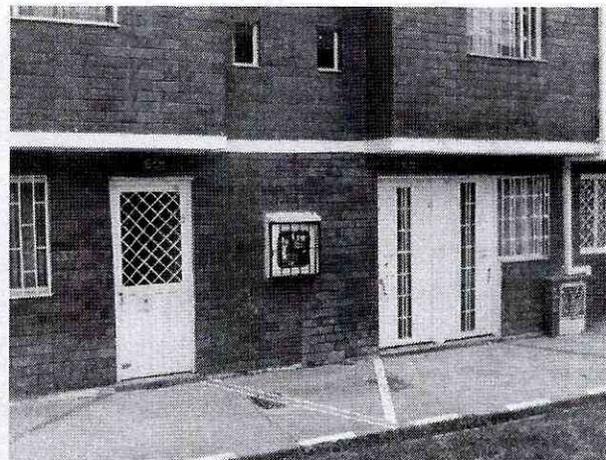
Vista de uno de los sectores de la urbanización Valles de Cafam, donde se observa la configuración constructiva y estructural de las viviendas emplazadas en esta urbanización.
